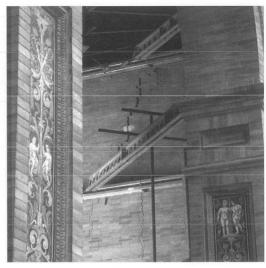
Imagen actual del arriostramiento de la Terraza de las Palomas. Torre norte, fachada Sur (Fuente documental propia)
